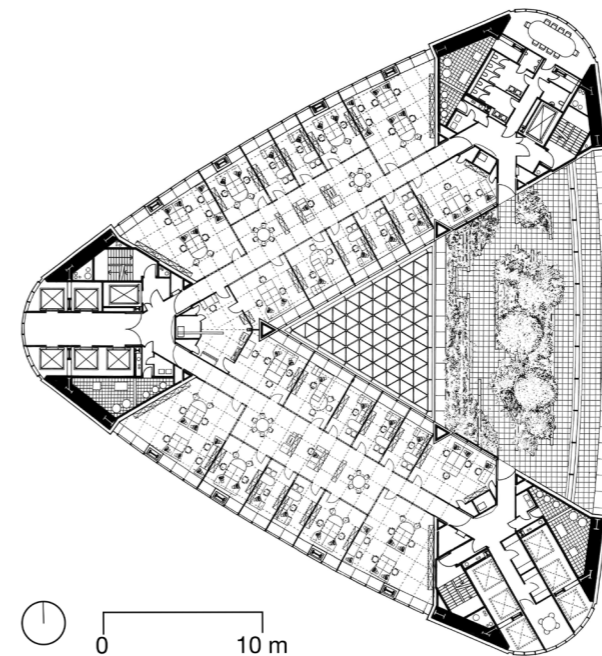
| Planta tipo Commerzbank. Fuente: Foster + Partners.
